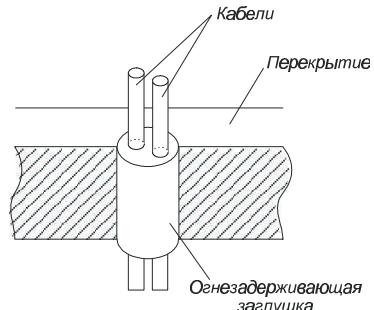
Проход межэтажного перекрытия кабелями с сертификатами уровней 3 и 4
